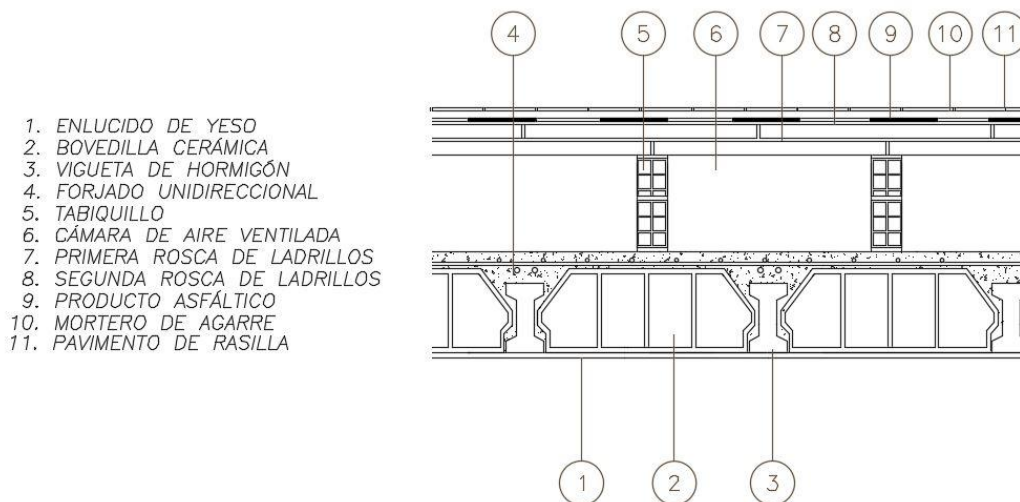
Detalle constructivo de la cubierta del grupo Federico Mayo. Fuente: Fundación Goerlich
